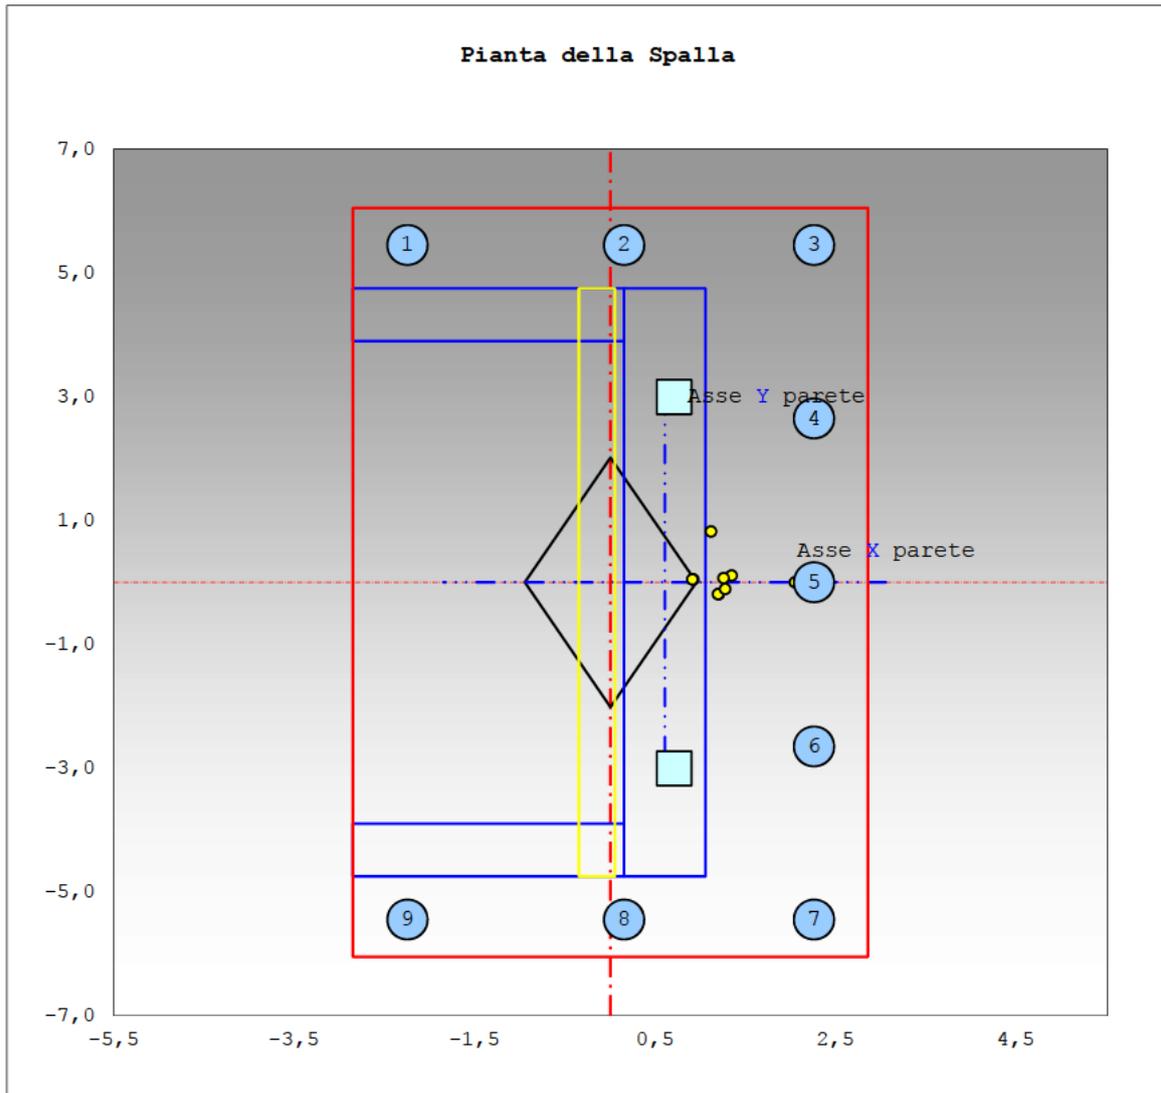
Schematizzazione planimetrica della spalla
